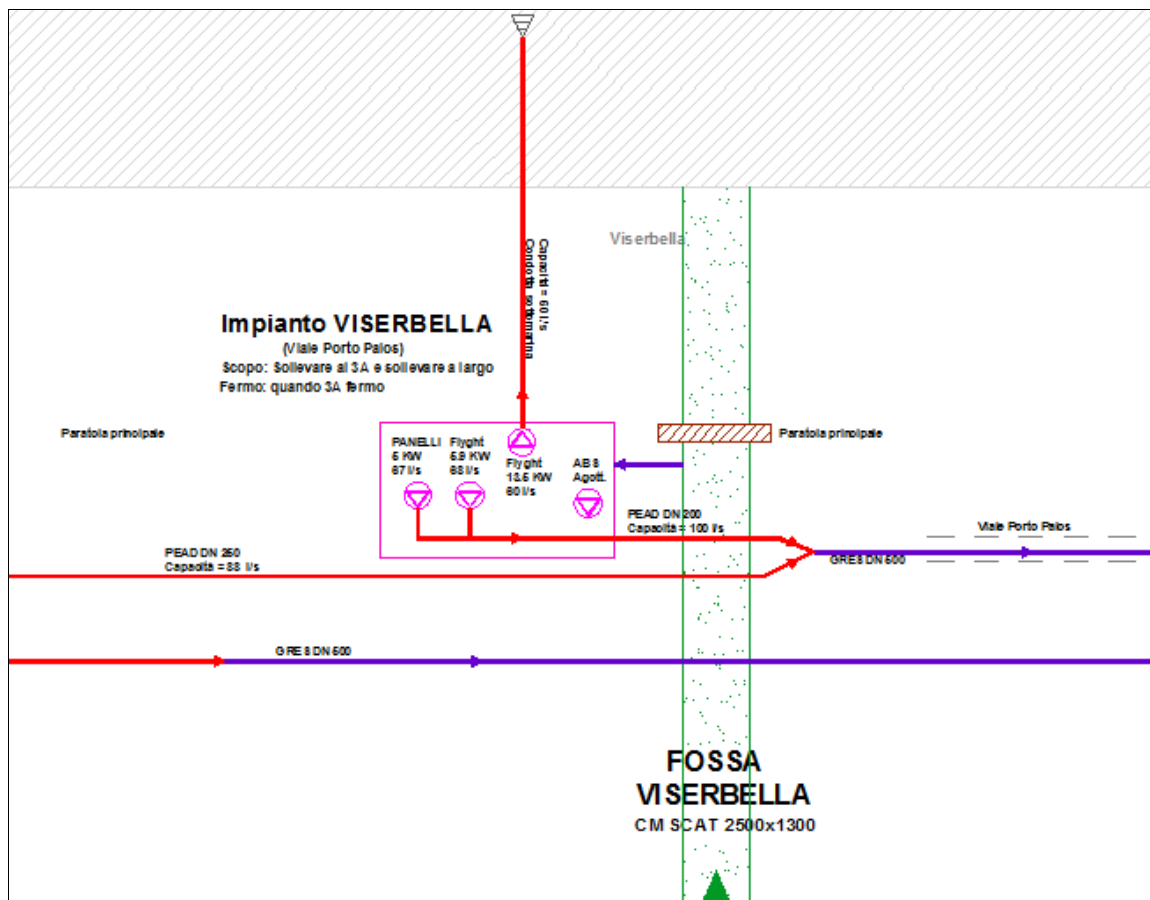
Schema impiantistico dell'impianto Viserbella
